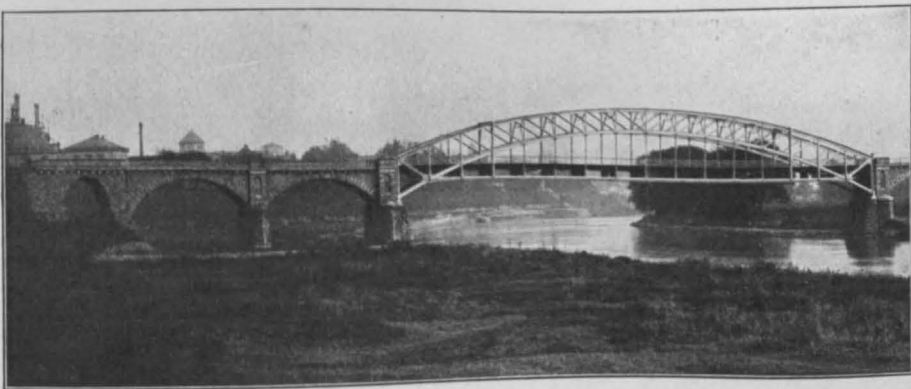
Mainbrücke der Lokalbahn Schweinfurt-Gerolzhofen. 1903.
